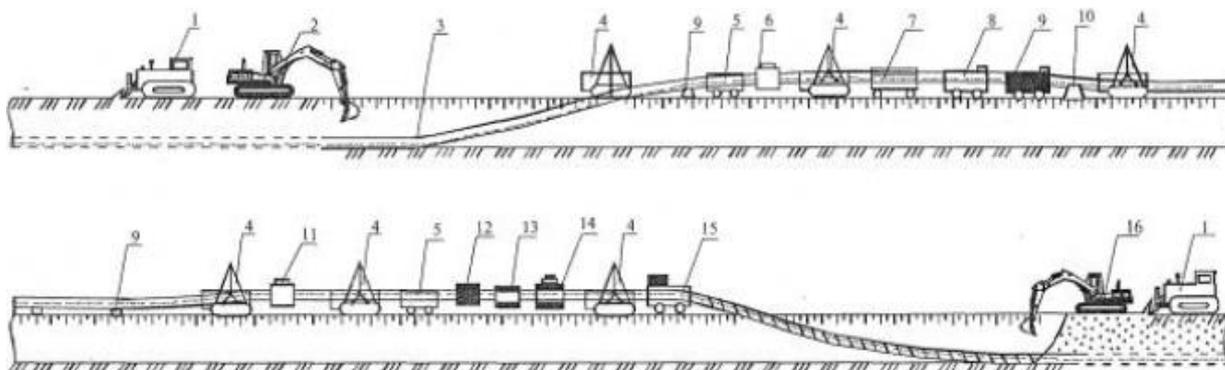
Принципиальная схема капитального ремонта газопровода на берме траншеи:
